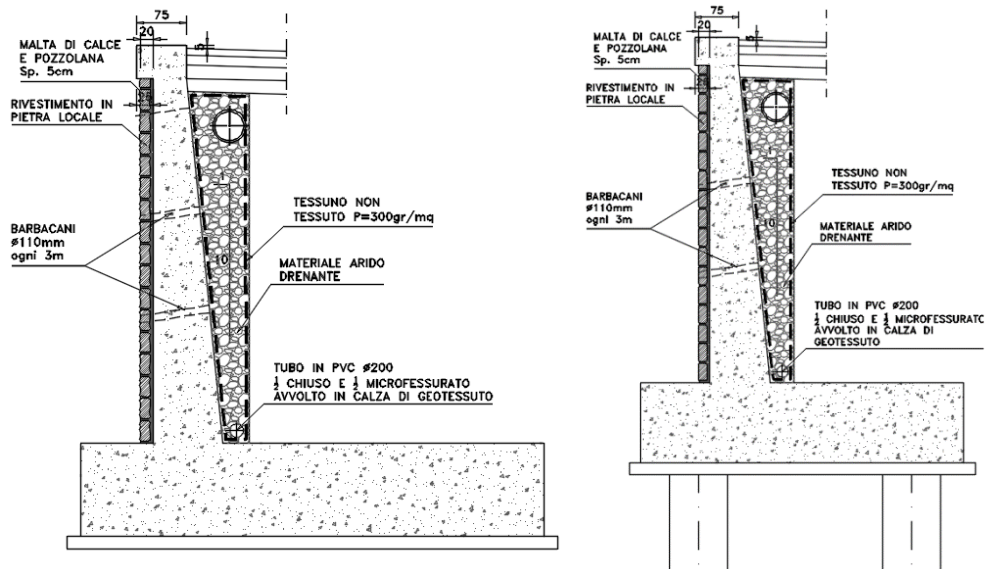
Sezione tipo muro di sostegno su fondazione diretta (a sx) e sezione tipo muro di sostegno su pali (a dx).
